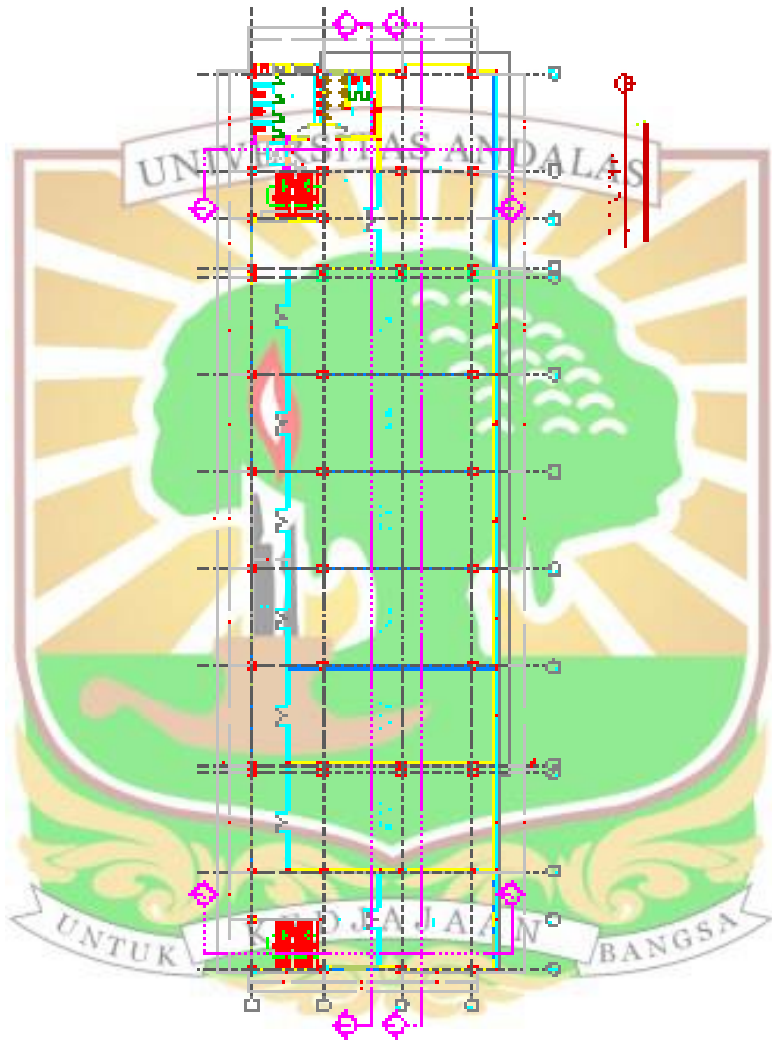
Denah Lantai 1 Gedung *Hospitality Center
